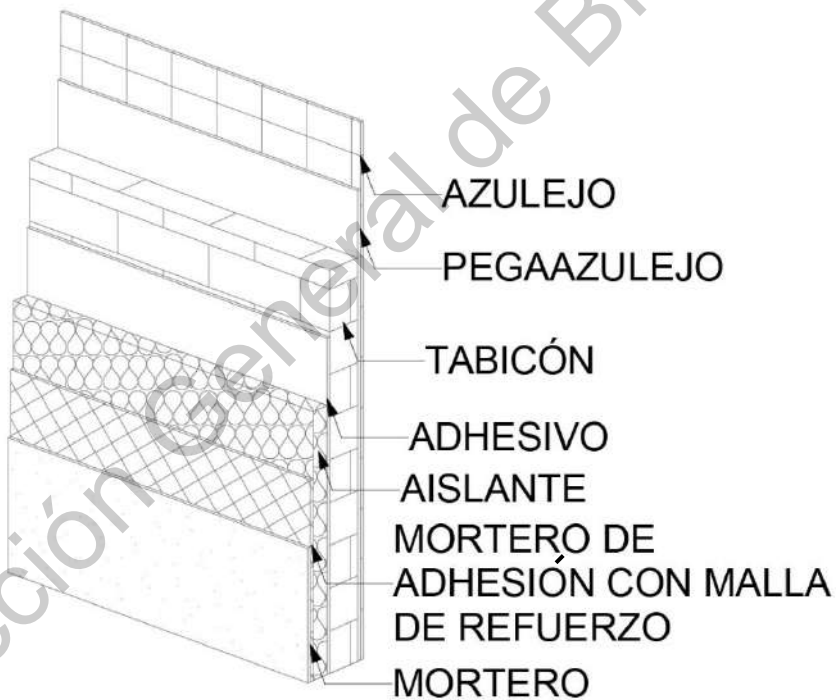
Detalle de muro de azulejo con aislante térmico. Elaboración propia.
